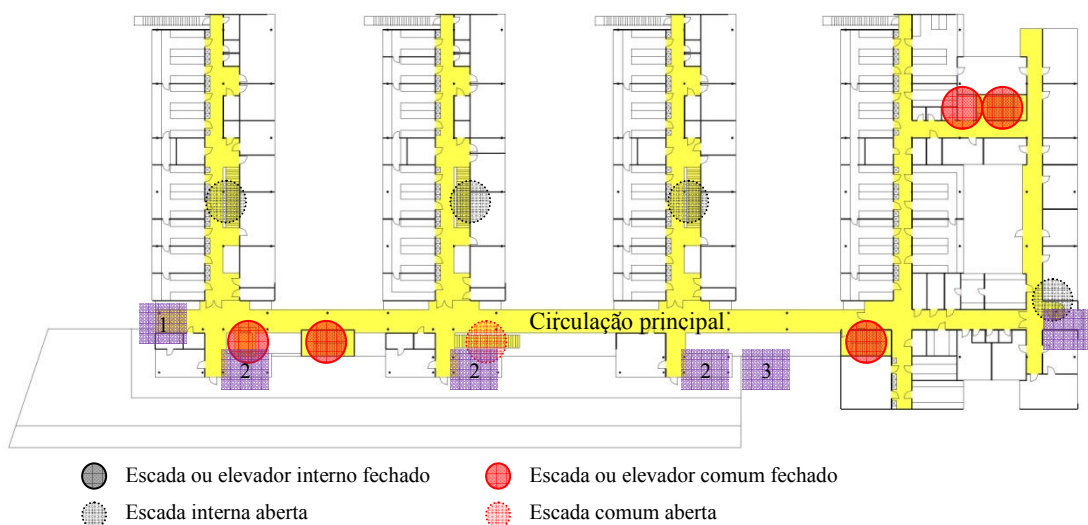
Planta do 2º pavimento do Centro A com estrutura da circulação indicada em amarelo, circulações verticais e locais para encontros. Fonte: elaborado pelo autor com dados do SOCIEDADE MAX PLANCK, 2002a, p. 6.
